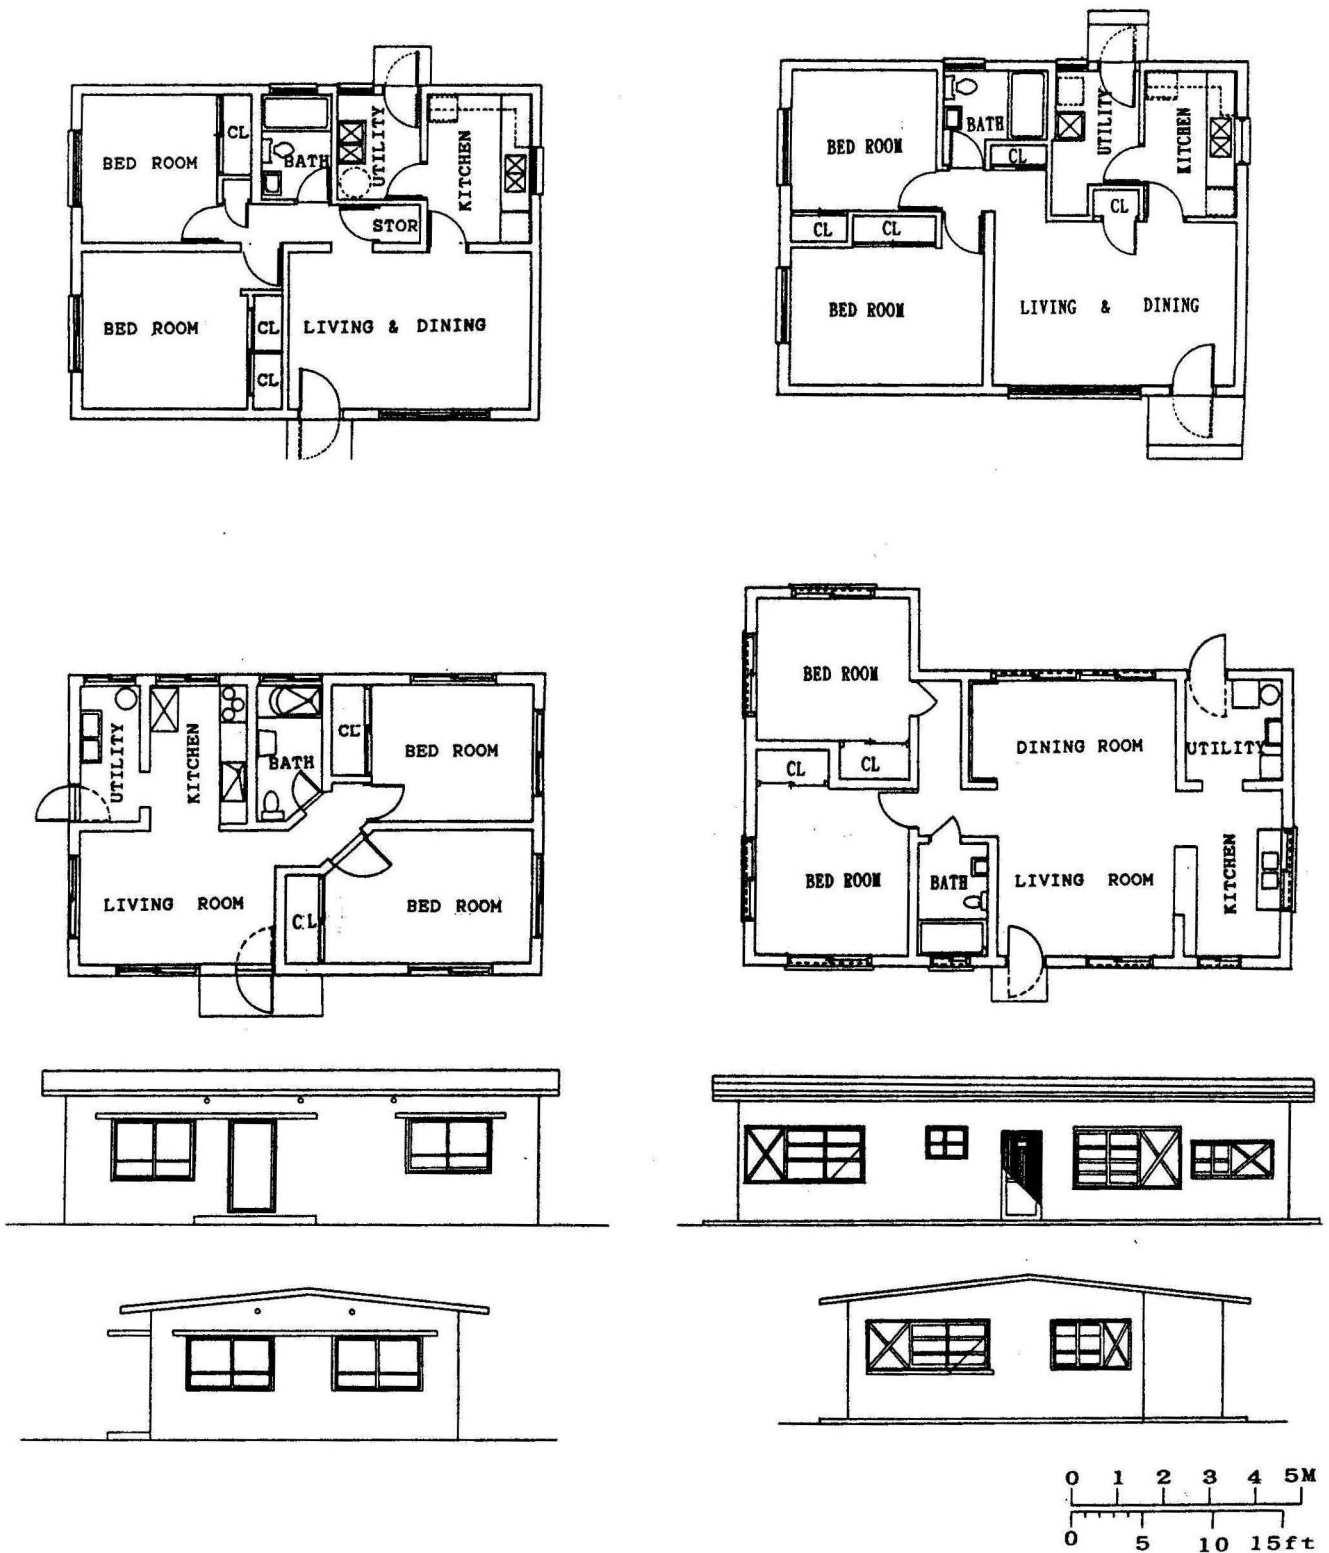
外人住宅平面図及び立面図 (2ベッドルームタイプ)
